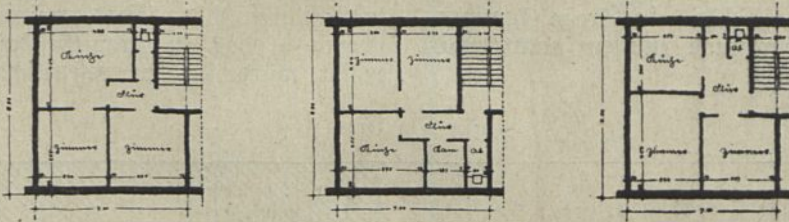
Schematische Darstellung der drei Hauptgrundrißformen des eingebauten Einfamilienhauses.
